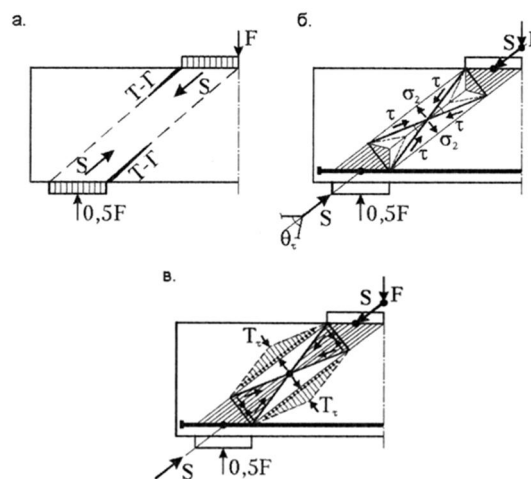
Схема поэтапного сопротивления разрушению сжатой полосы бетона в коротких балках:
